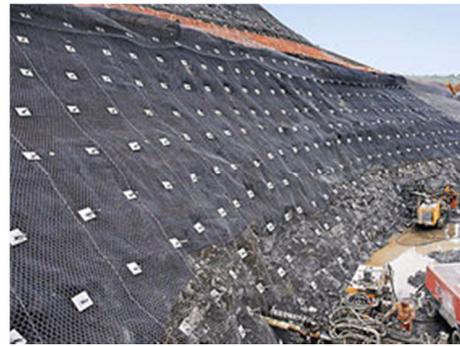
Sistema de geomanta complementados con sistema de anclaje.
